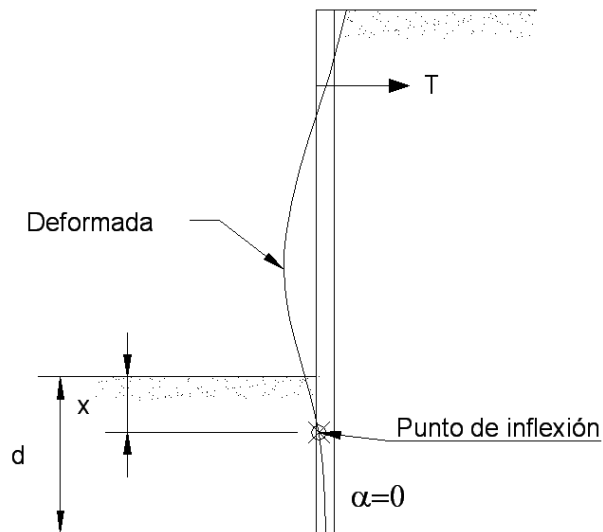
Deformada de pantalla anclada en soporte fijo
